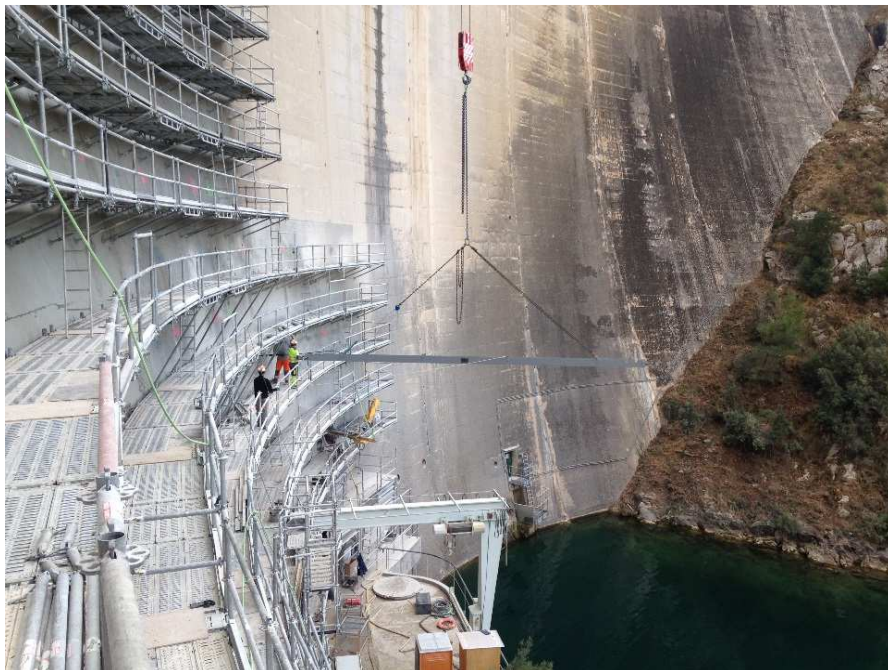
Mise en place d'une barre d'ancrage au pied du barrage
